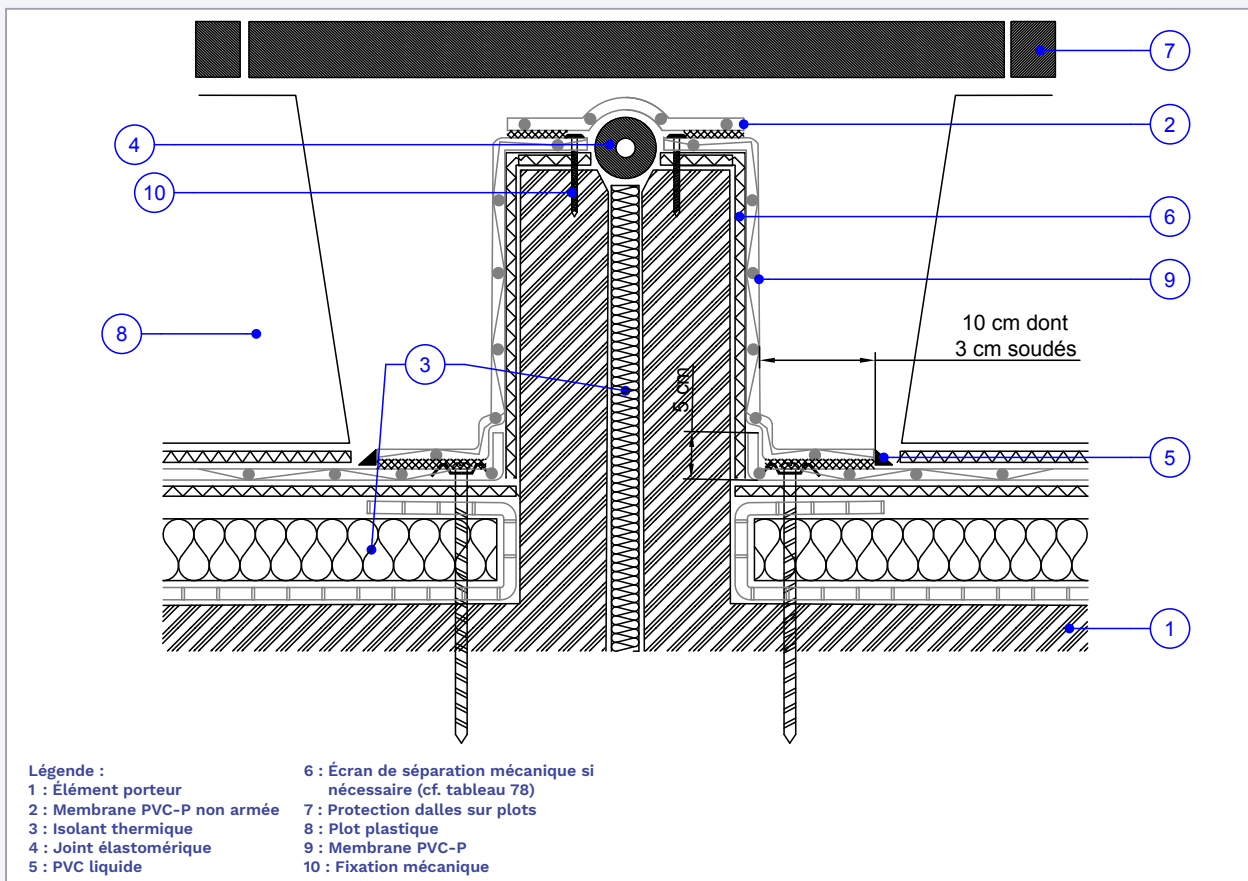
Joint de dilatation plat surélevé sur maçonnerie avec dalles sur plots
